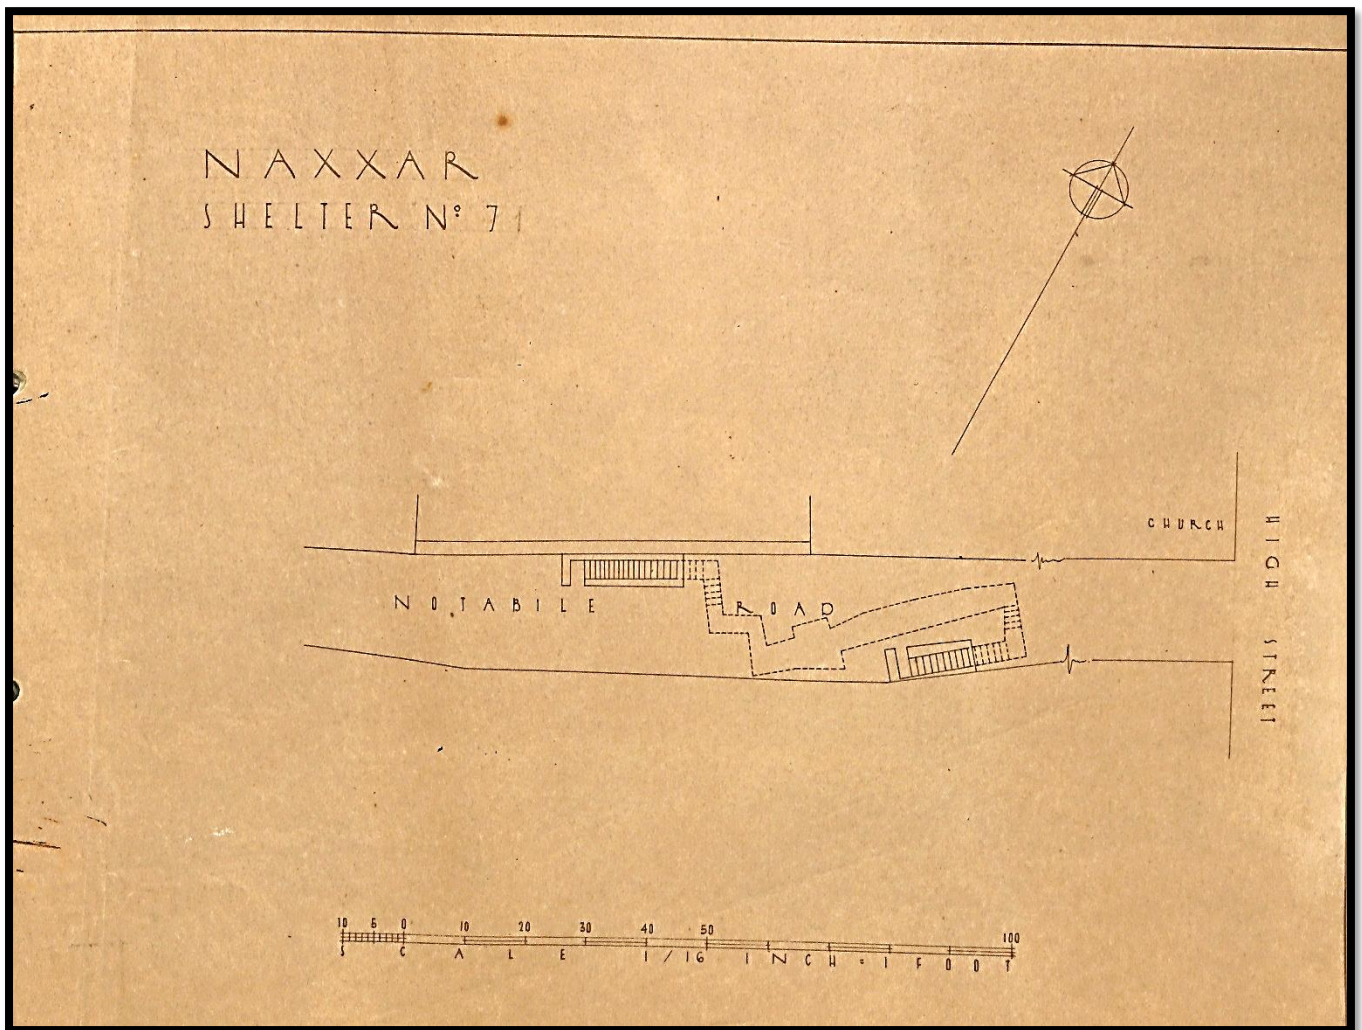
Planta do Abrigo nº7 (1) "Notabile Road – High Street."
